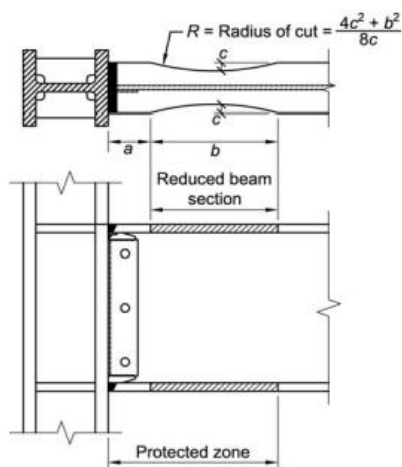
Configuração e dimensões das ligações com Viga de Secção Reduzida (ANSI/AISC 358, 2010a)
